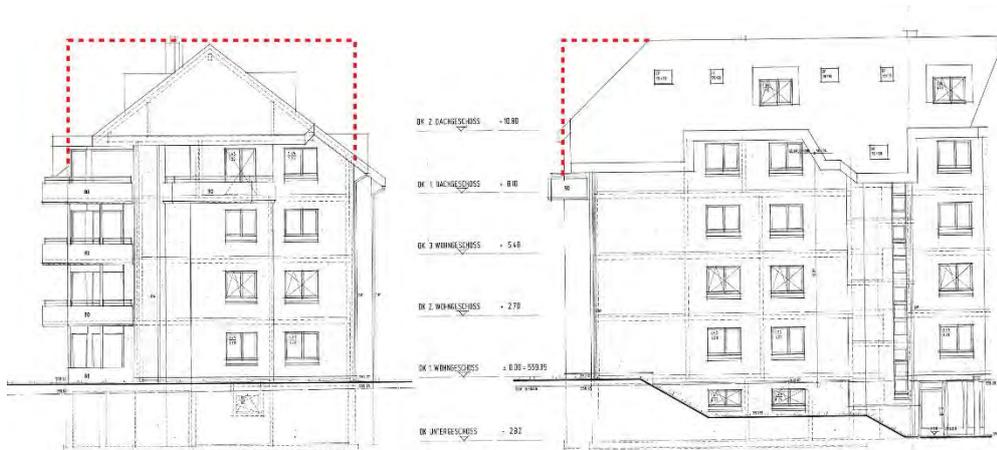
Skizze Potenzial Ausbau Dachgeschosse
